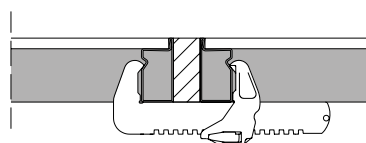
Vue détaillée de la serrure réglable Uni
